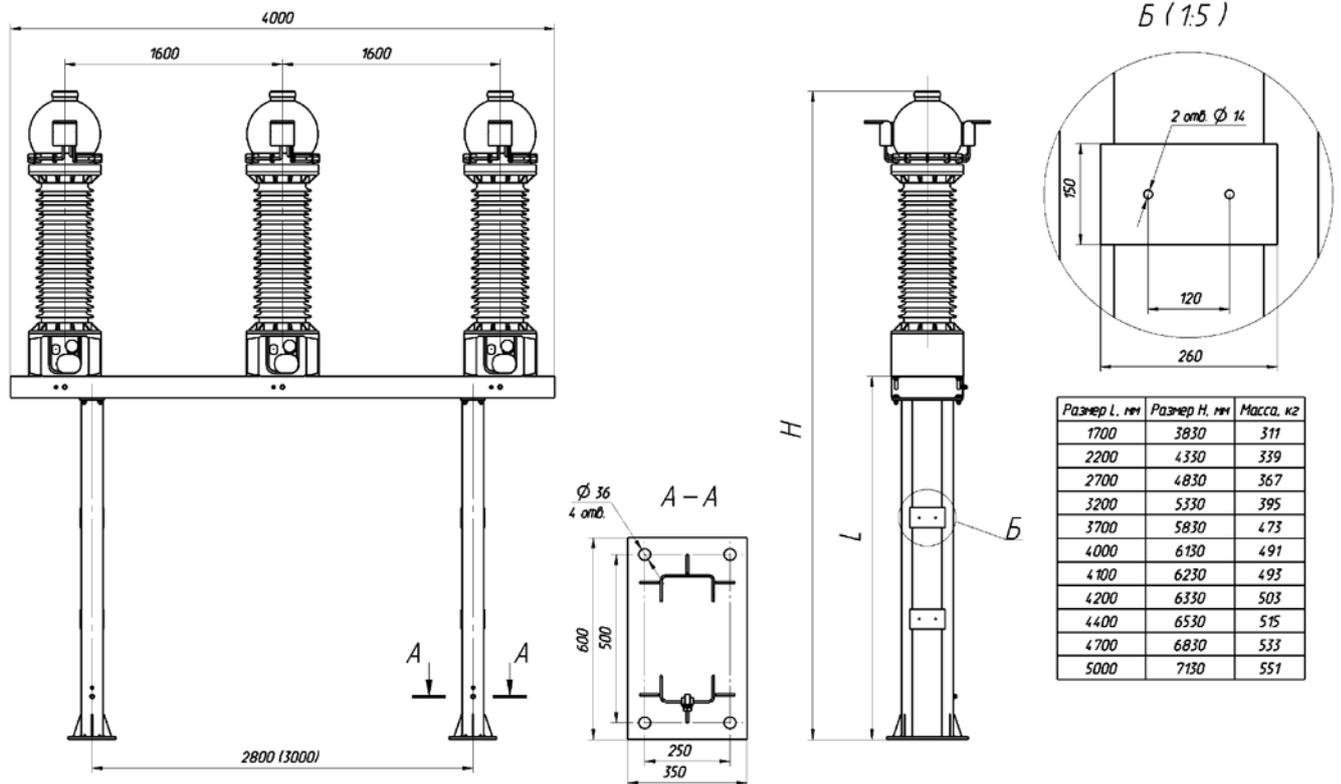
Установка блока трансформаторов тока ТРГ-УЭТМ®-110- на заводской металлоконструкции с покрытием горячим цинком.
